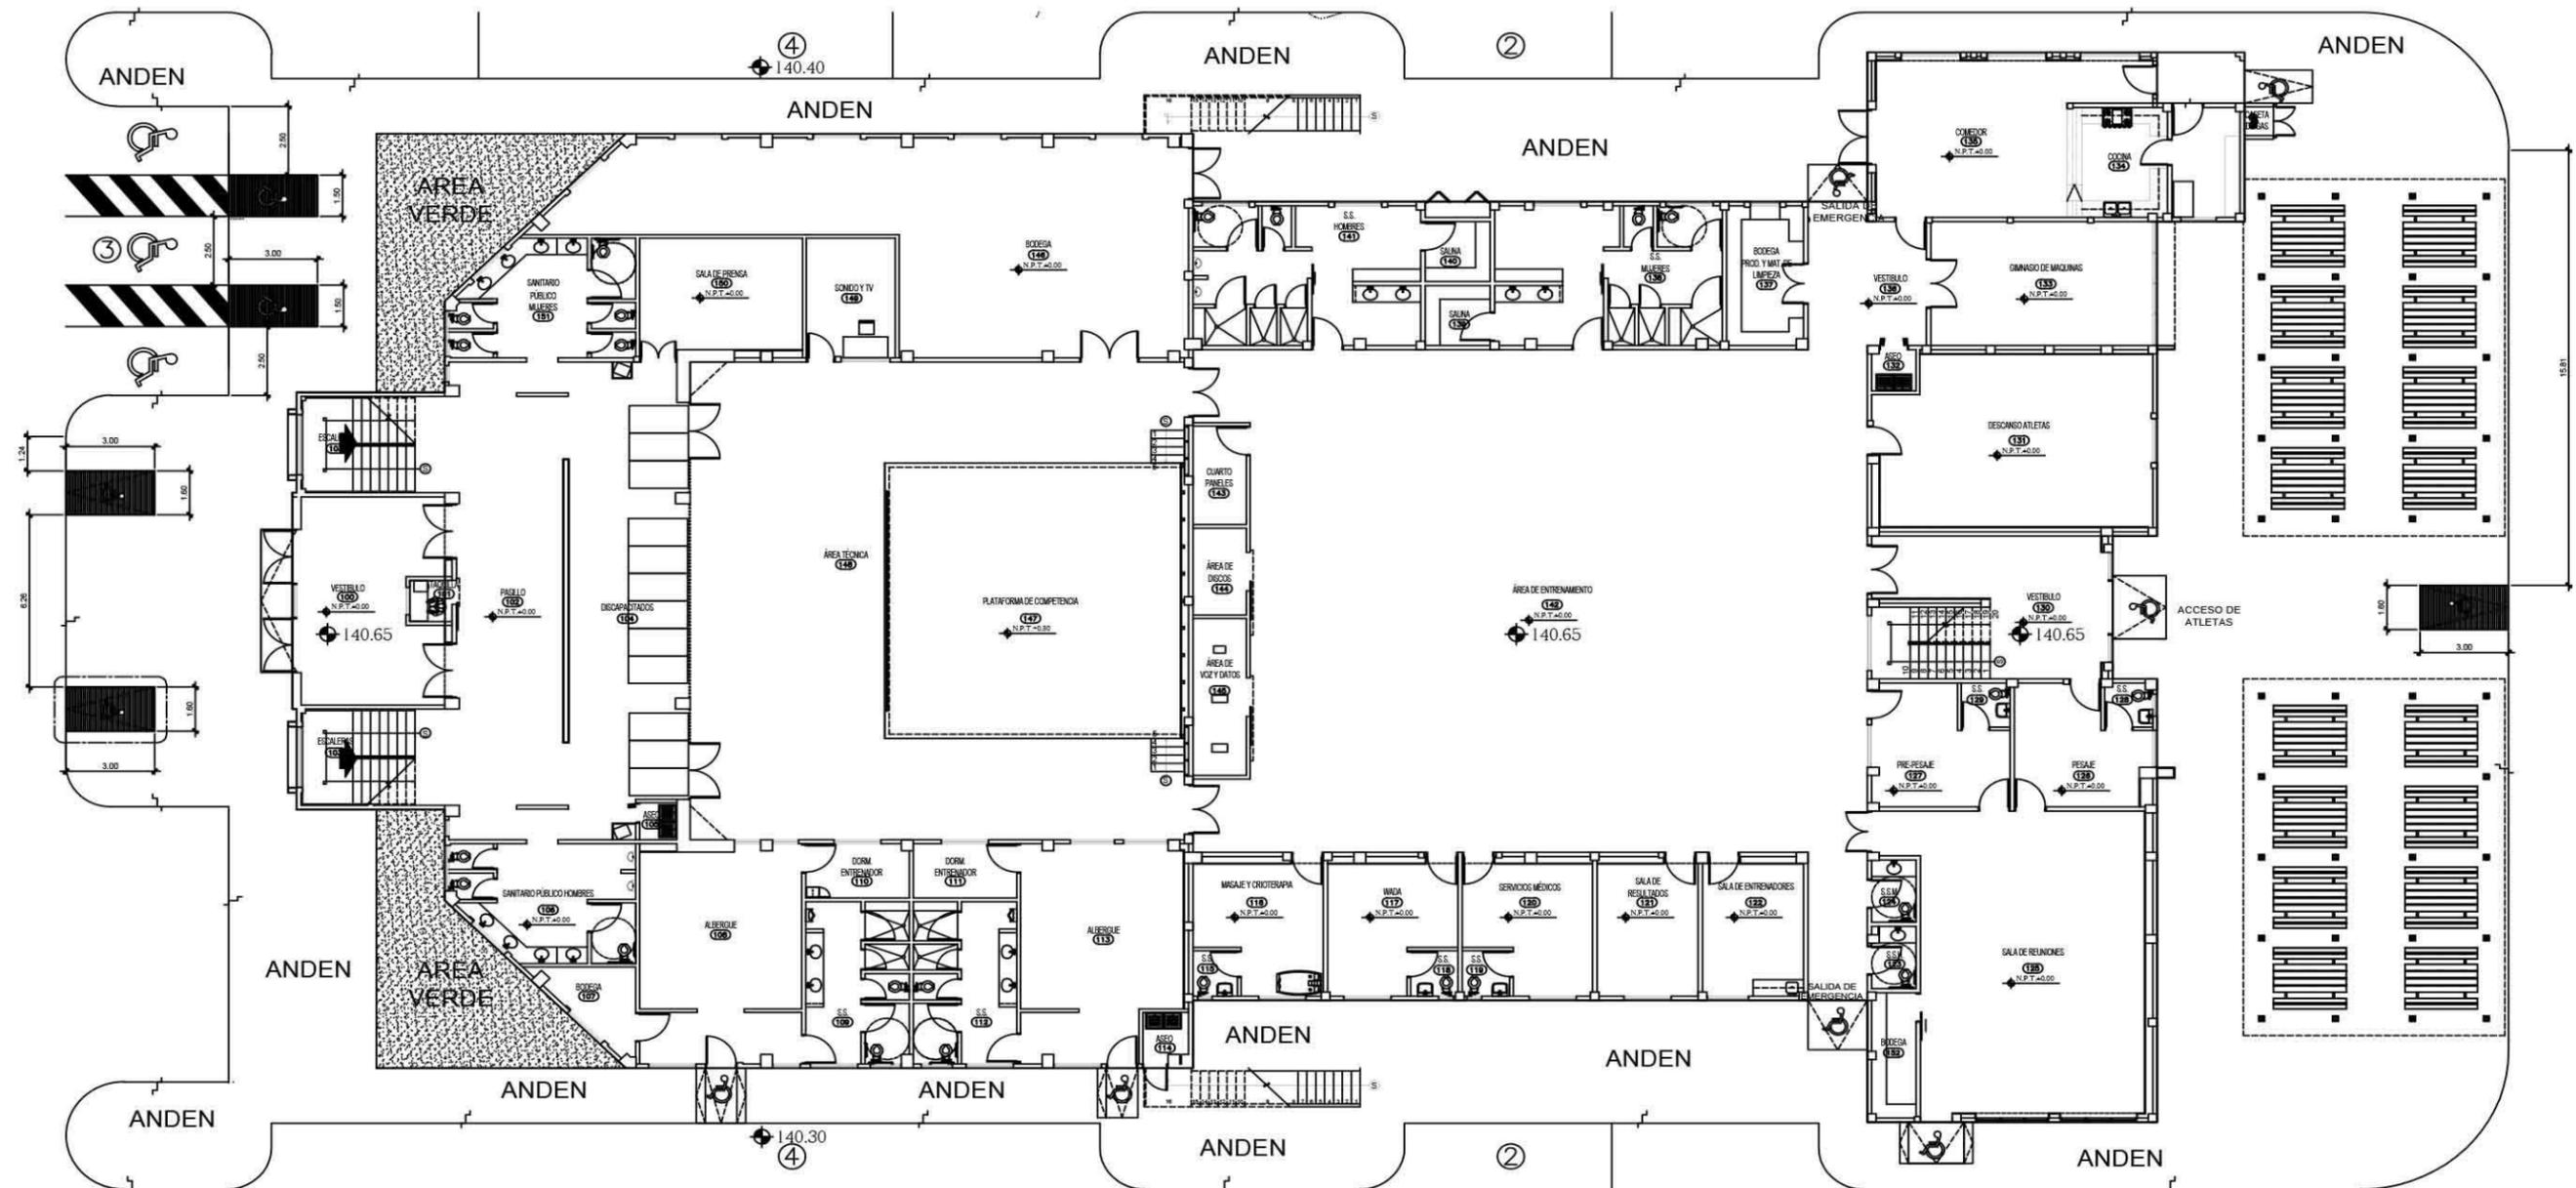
Plano de andén y rampas modificado por la Practicante
